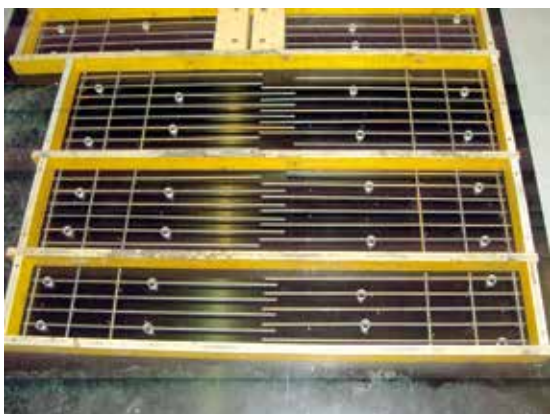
Schalung mit Stabstahlbewehrung für die Versuchskörper der Vierpunktbiegeversuche
